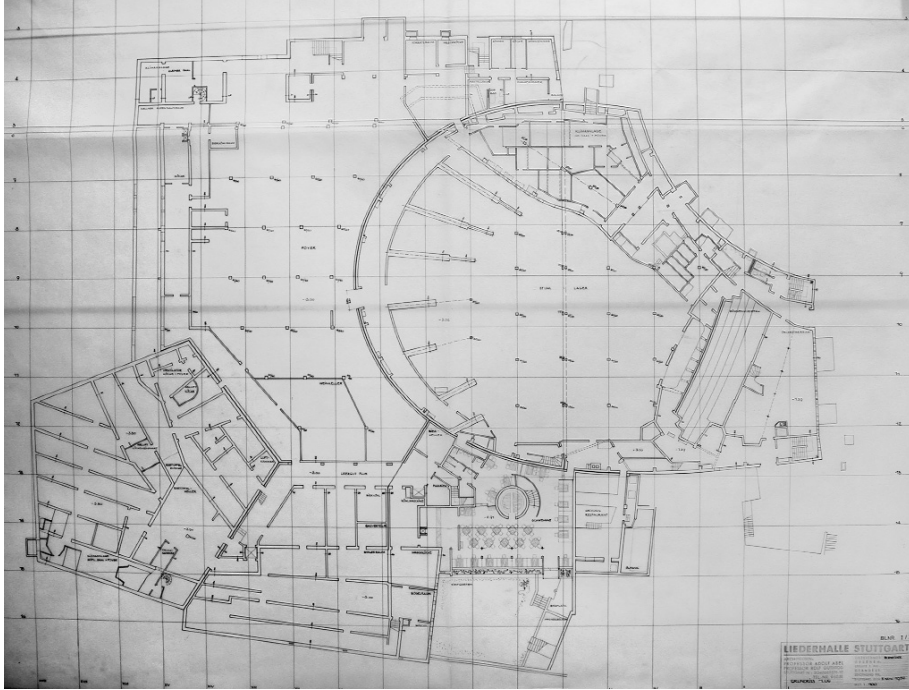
Grundriss, 1. Untergeschoss, Büro Gutbrod, 1955.
